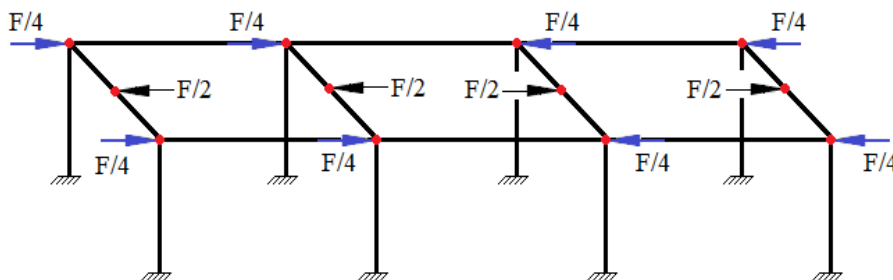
Esquema de la fuerza de trabajo sobre las columnas y vigas
